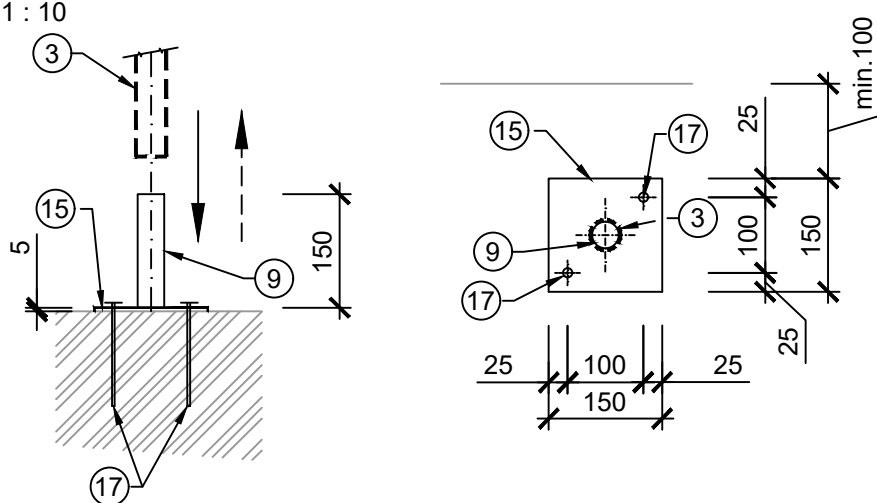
DETAIL - Kotvení z boku do nosné kce zaroštování M 1:10
